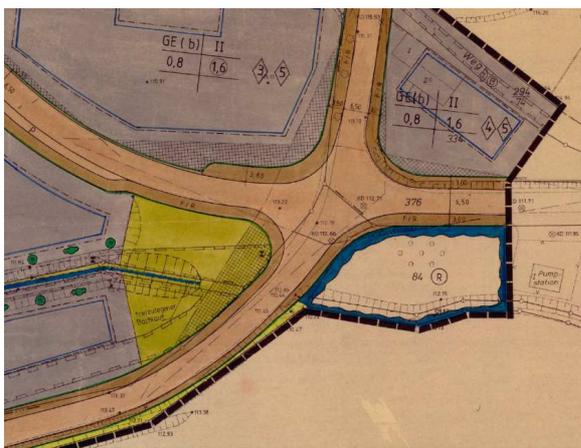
Beb. - Plan Nr. 18 „Stehfenstraße“
